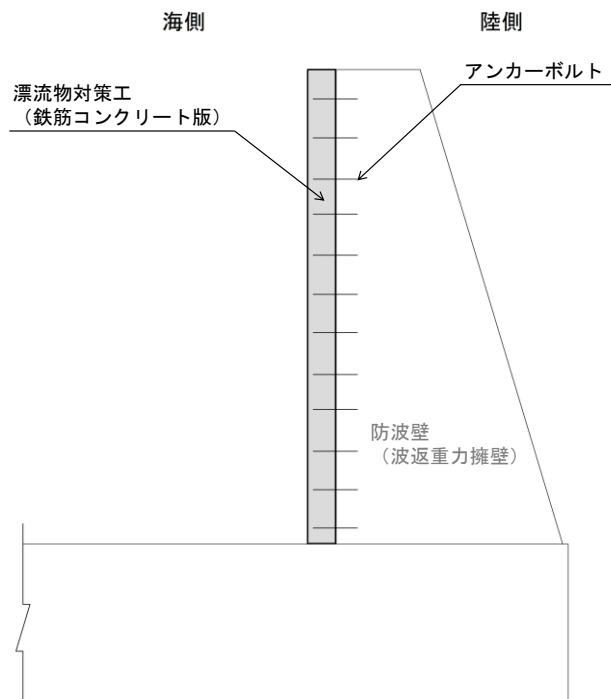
漂流物対策工（鉄筋コンクリート版）の評価対象部位
